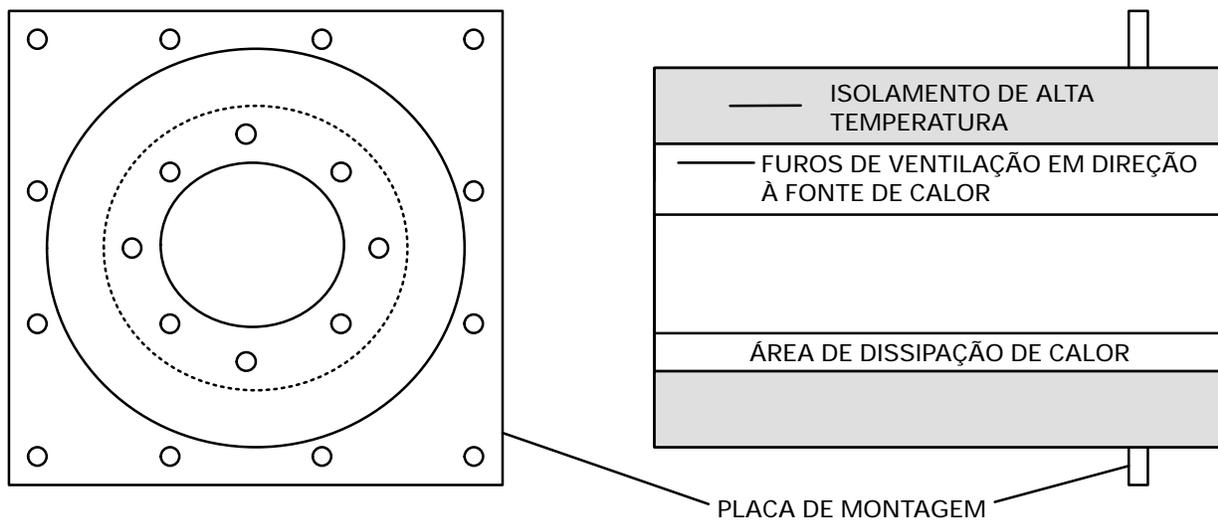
Construção Típica de Ilhéu para Instalações em Paredes Inflamáveis
